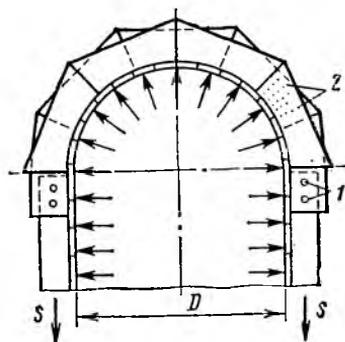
Схема нагружения кружалных ребер опалубки: 1 — болты; 2 — гвозди
